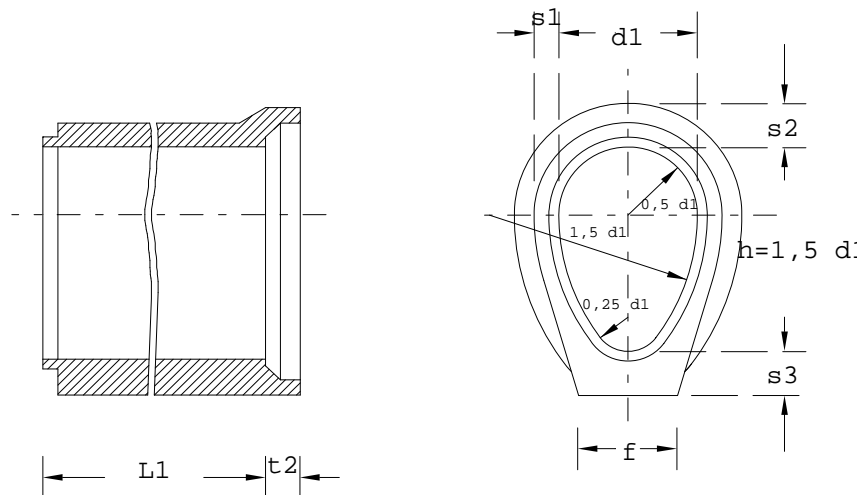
tubo in calcestruzzo di sezione ovoidale con manicotto e piede di appoggio
